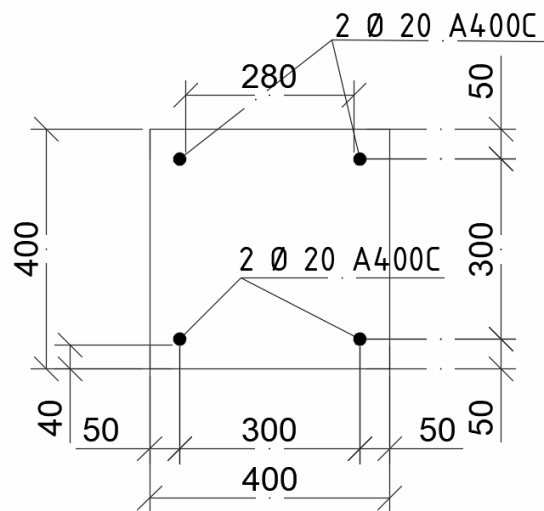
Схема армування залізобетонного монолітного армопоясу
